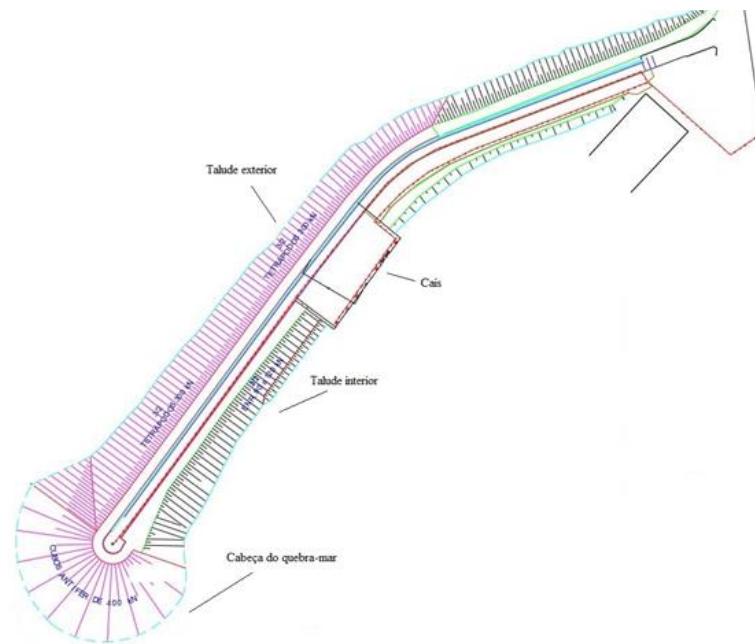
Planta do molhe cais do porto da Ericeira.
